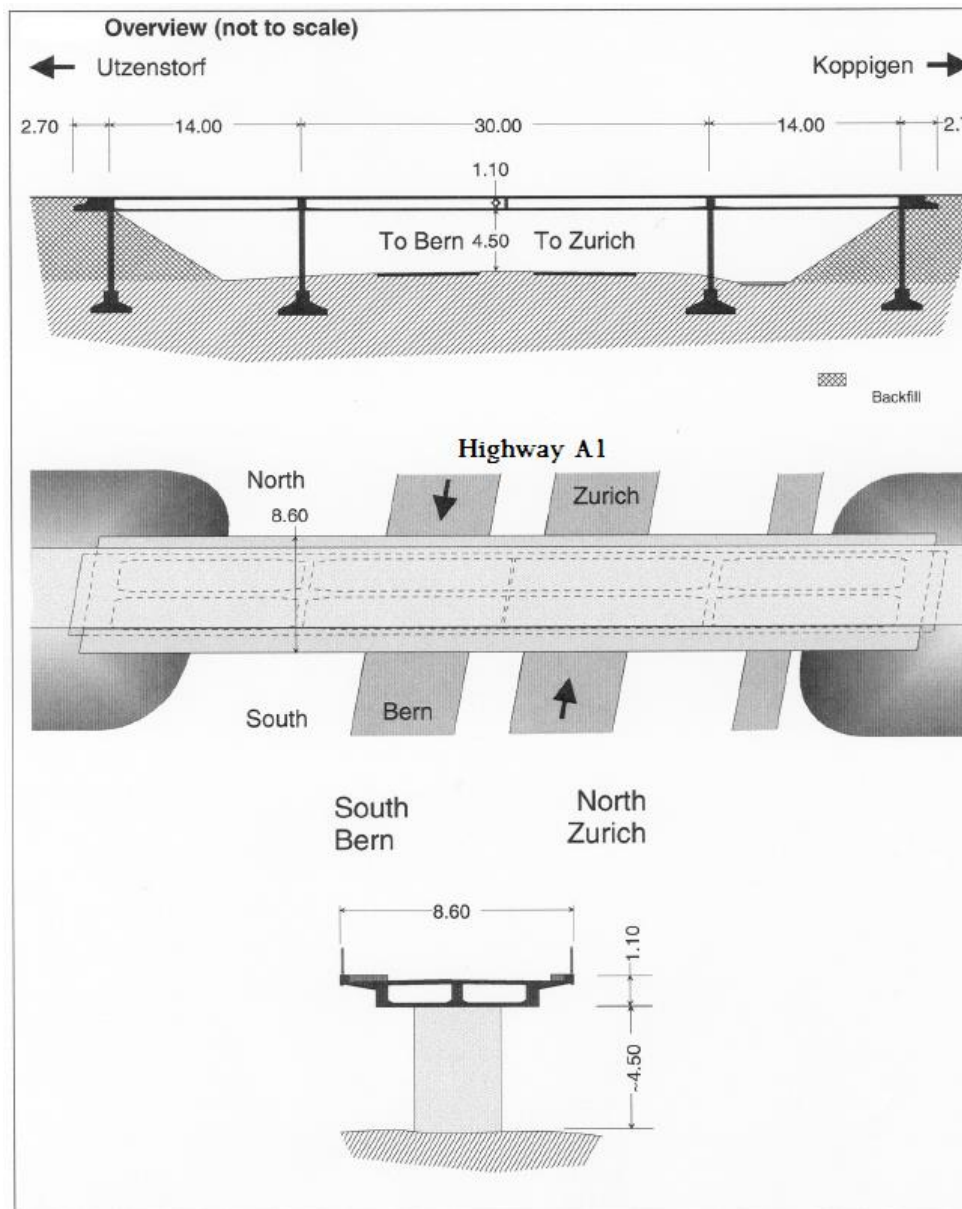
Vista em planta e corte longitudinal e transversal da passagem superior Z24 [48]
